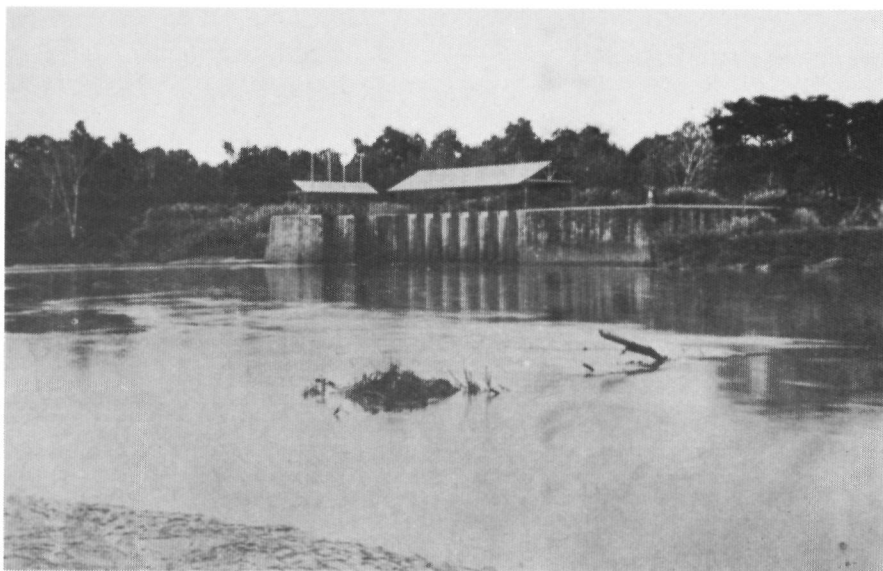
Stuw en inlaatsluis te Notok (bovenstrooms) (uit: Verslag BOW 1909)
